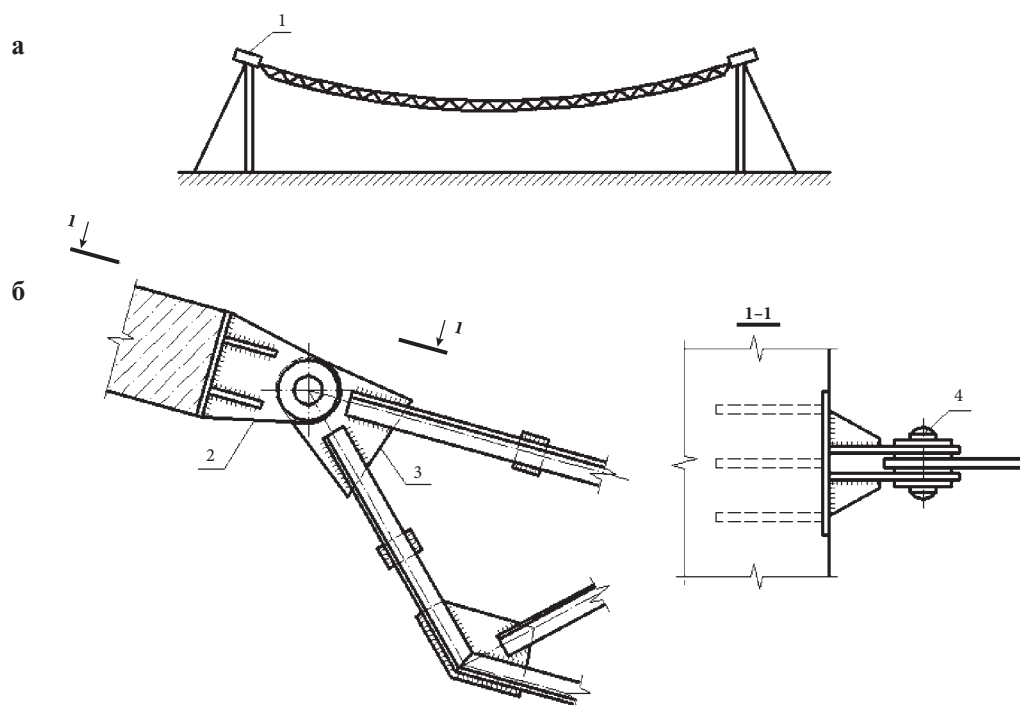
Покрытие с висячими фермами: а) пример конструктивной схемы; б) узел крепления висячей фермы к опорному контуру; 1 — бортовой элемент; 2 — ребра; 3 — фасонная деталь фермы; 4 — валик
